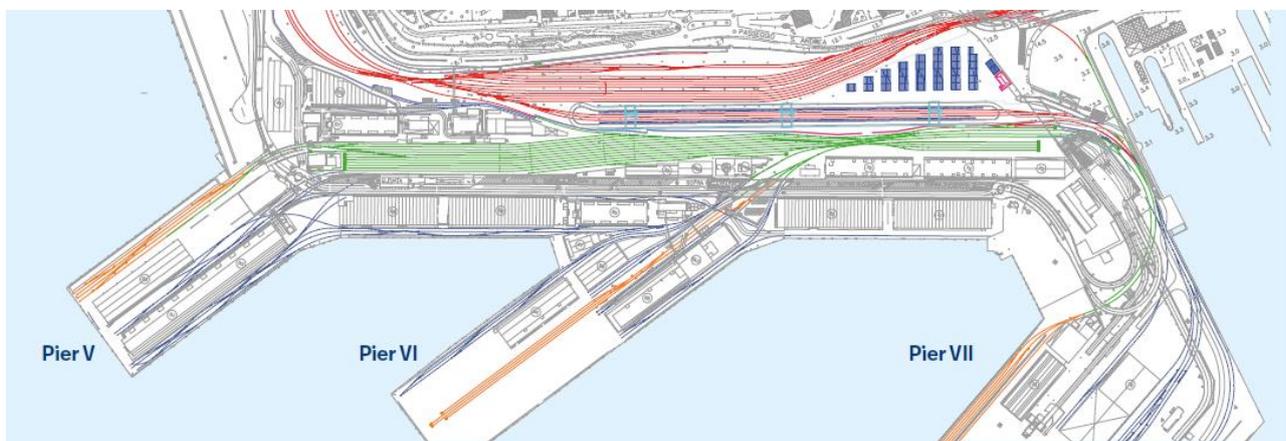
Estratto planimetrico della stazione ferroviaria Trieste Campo Marzio
